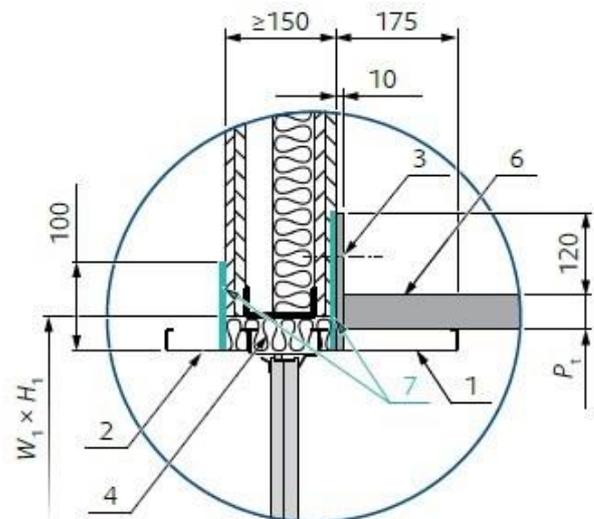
(EI90S) Sezione trasversale di installazione ☉ soft crossing in parete flessibile
